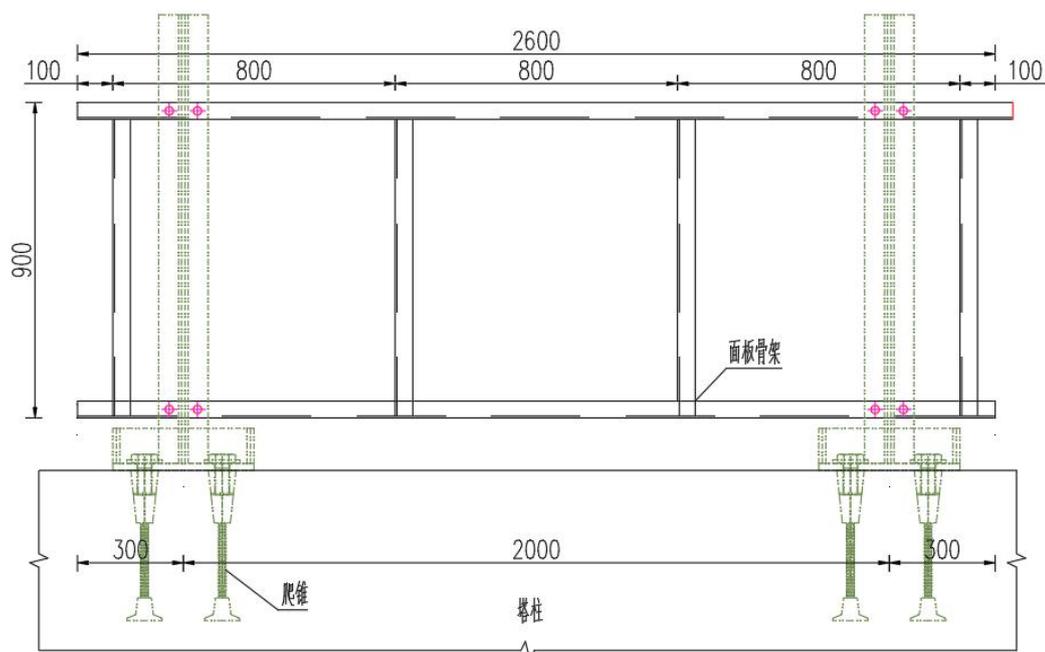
施工操作平台平面布置图 (单位: mm)
